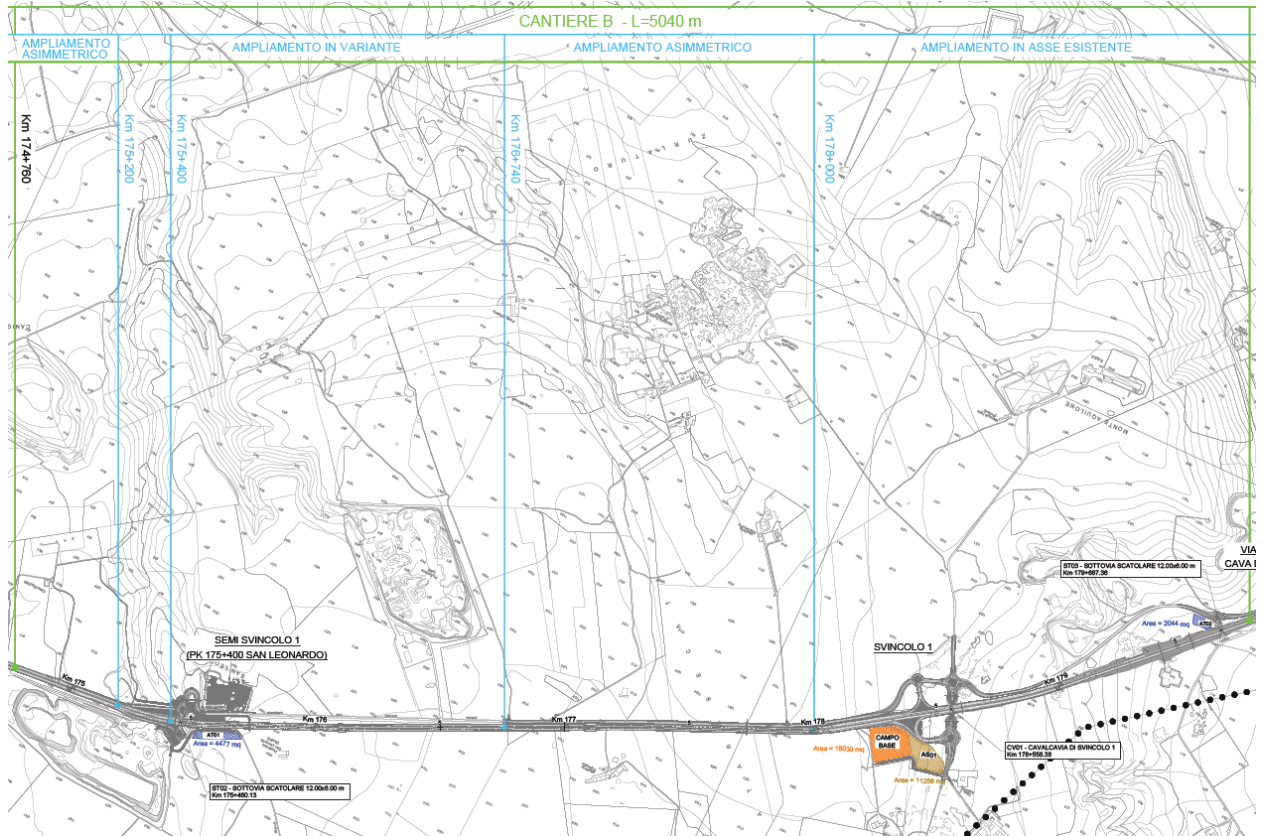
Stralci planimetrici con localizzazione Cantiere B
